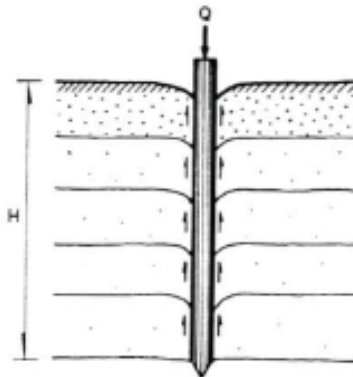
Pilas y pilotes de fricción, Manual de diseño y construcción de pilas y pilotes, SMMS, 1983.
